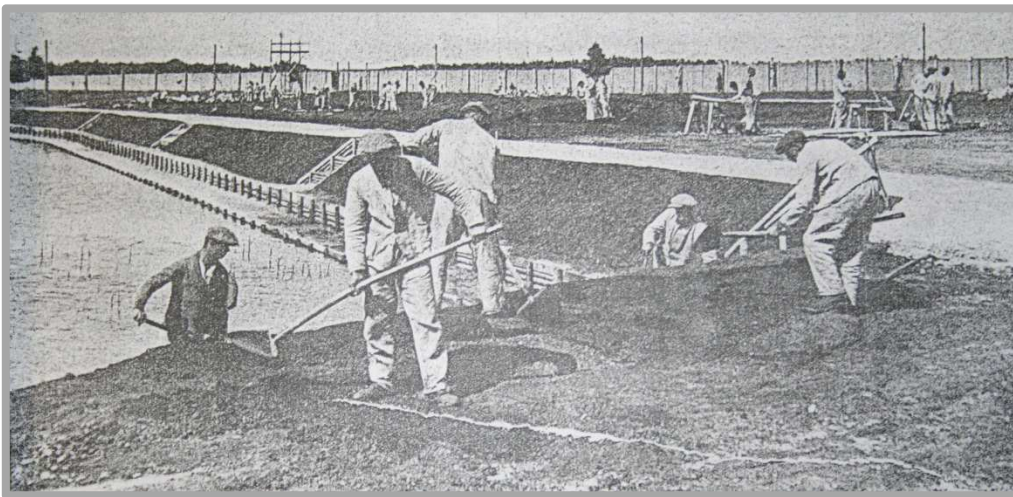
la construction du bassin de natation à Dachau. *Münchener Illustrierte Presse*, 16 juillet 1933<sup>238</sup>
